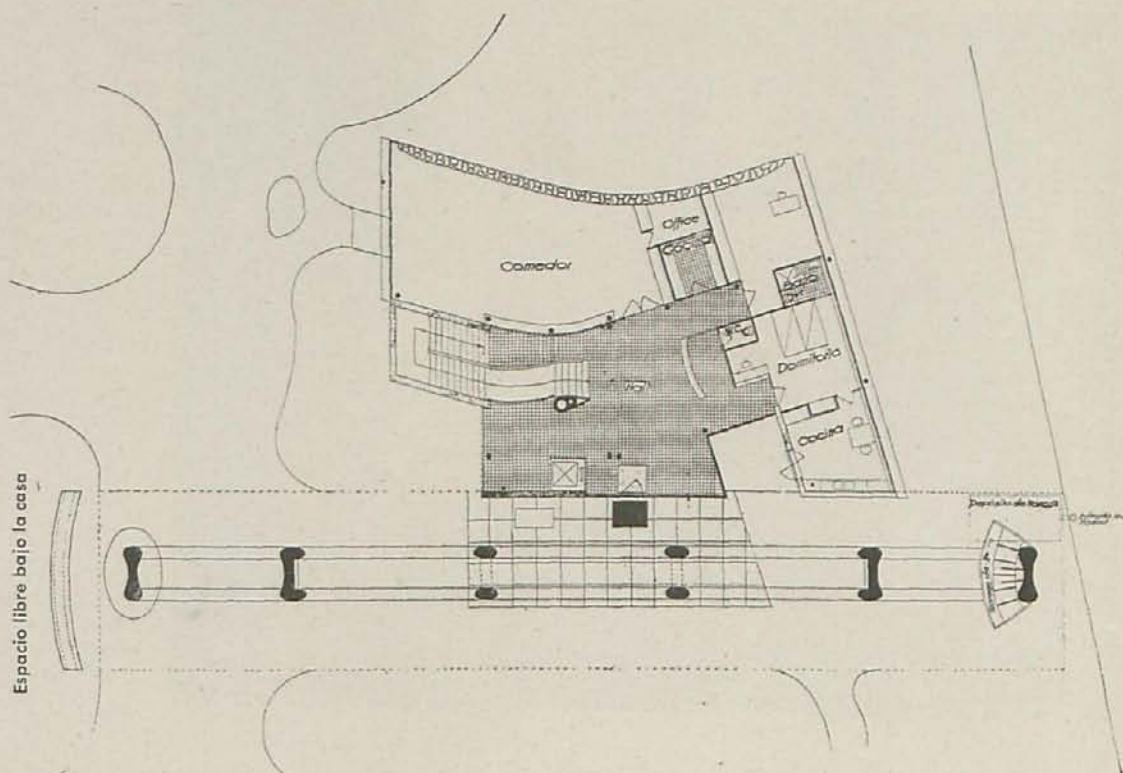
Pabellón suizo. París 1930-32. Planta del piso bajo a nivel del piso libre; es decir, con pilares. Los pilares del cuerpo principal y sus cimientos descenden hasta 19,50 metros por debajo de la calle. La solución adoptada de seis pilares produjo una considerable economía sobre los demás proyectos estudiados.
